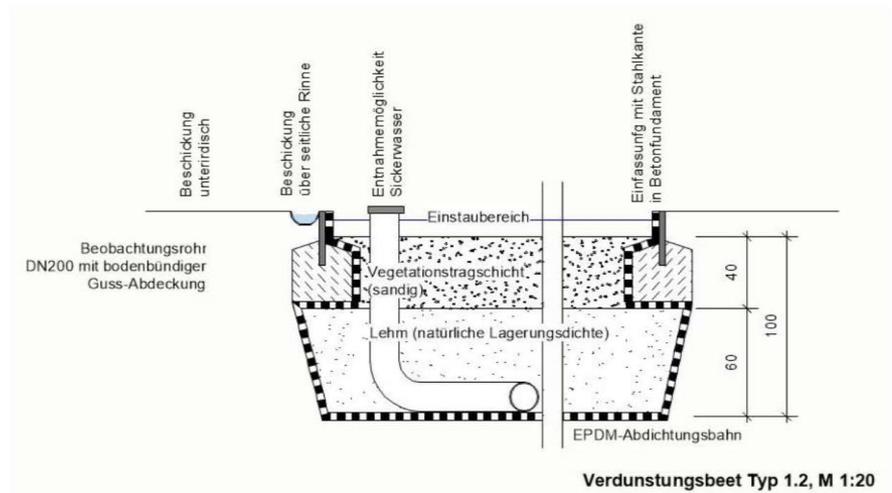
Detail Verdunstungsbeet Typ 1.2
